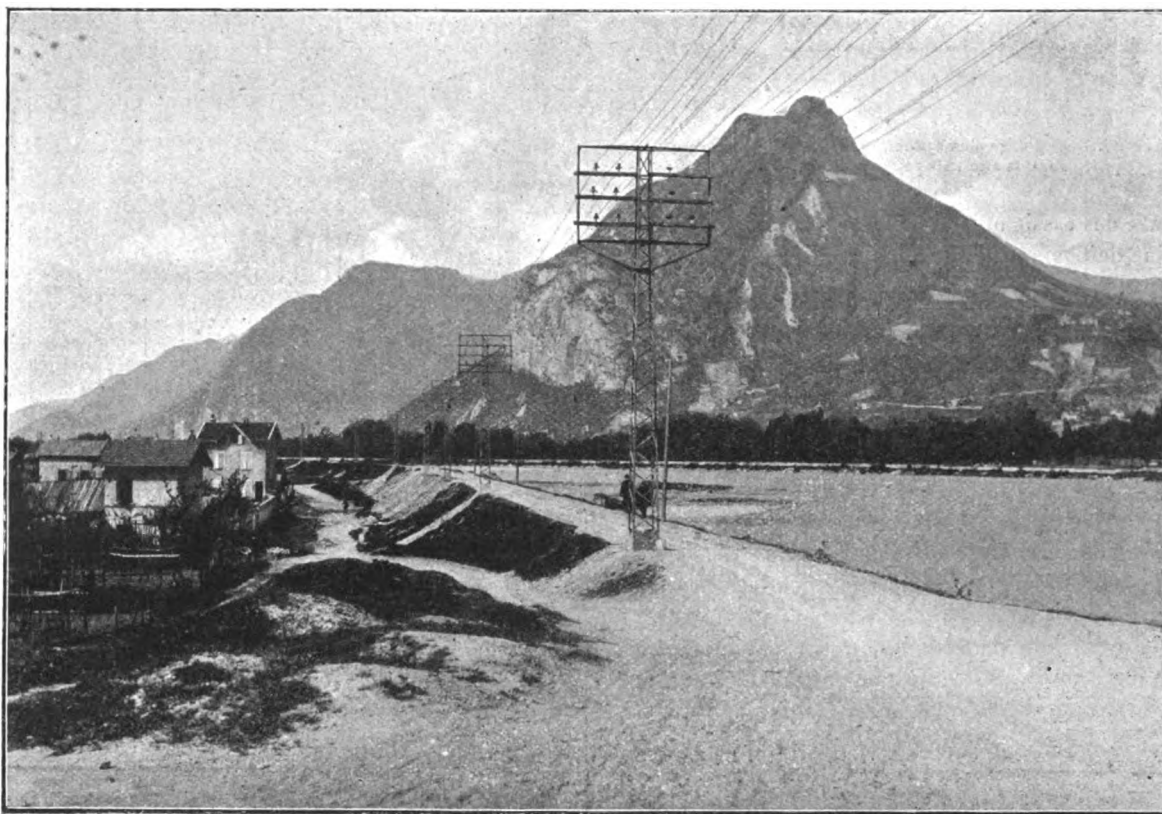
Vue d'ensemble de la ligne à haute tension.
